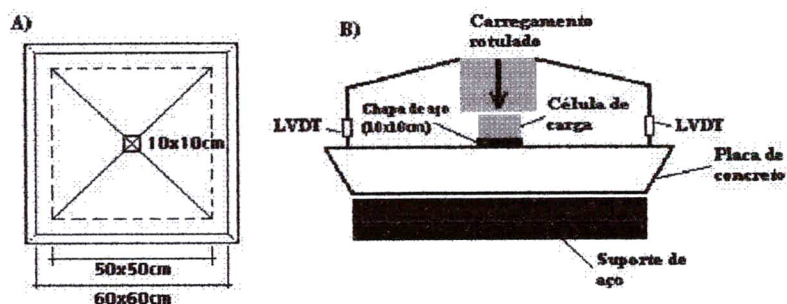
Ensaio de flexão em placa quadrada preconizado pela EFNARC (1996). a) Planta baixa do ensaio, b) Vista lateral do ensaio.
